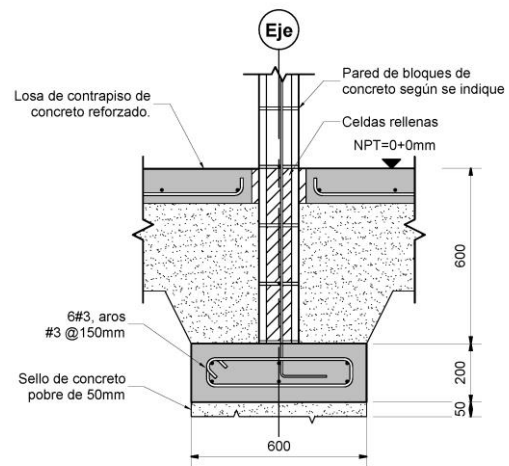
Detalle de placa corrida - Elaboración propia, 2024
